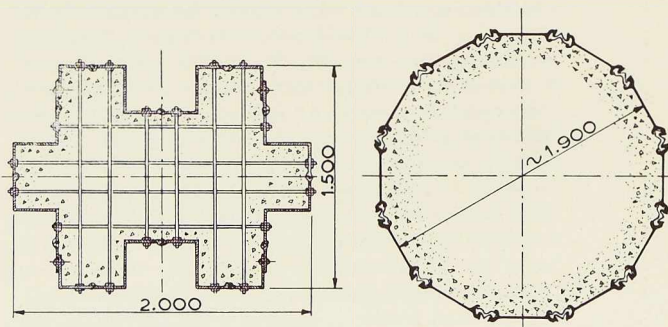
Caissons en palplanches métalliques. A gauche : palplanches Z, A droite : palplanches plates.
